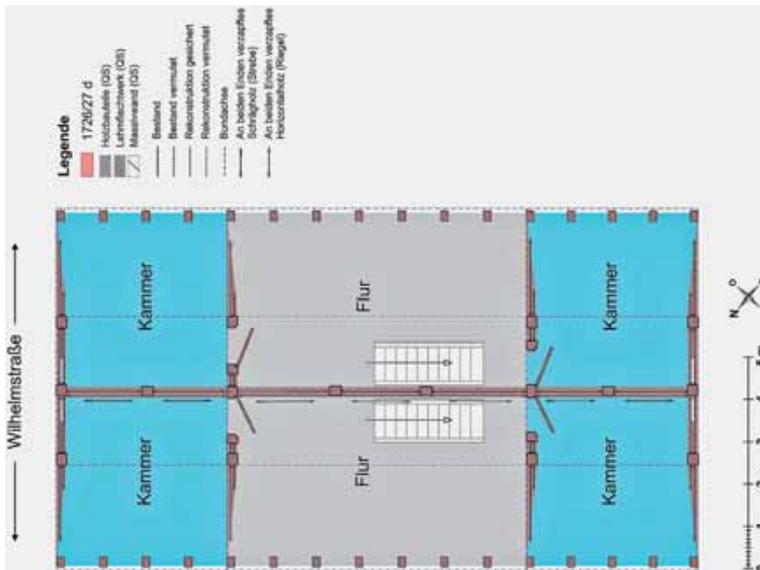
Reutlingen, Wilhelmstraße 74/76: Rekonstruktion des ursprünglichen Wohnungsgrundrisses im ersten Dachgeschoss.
